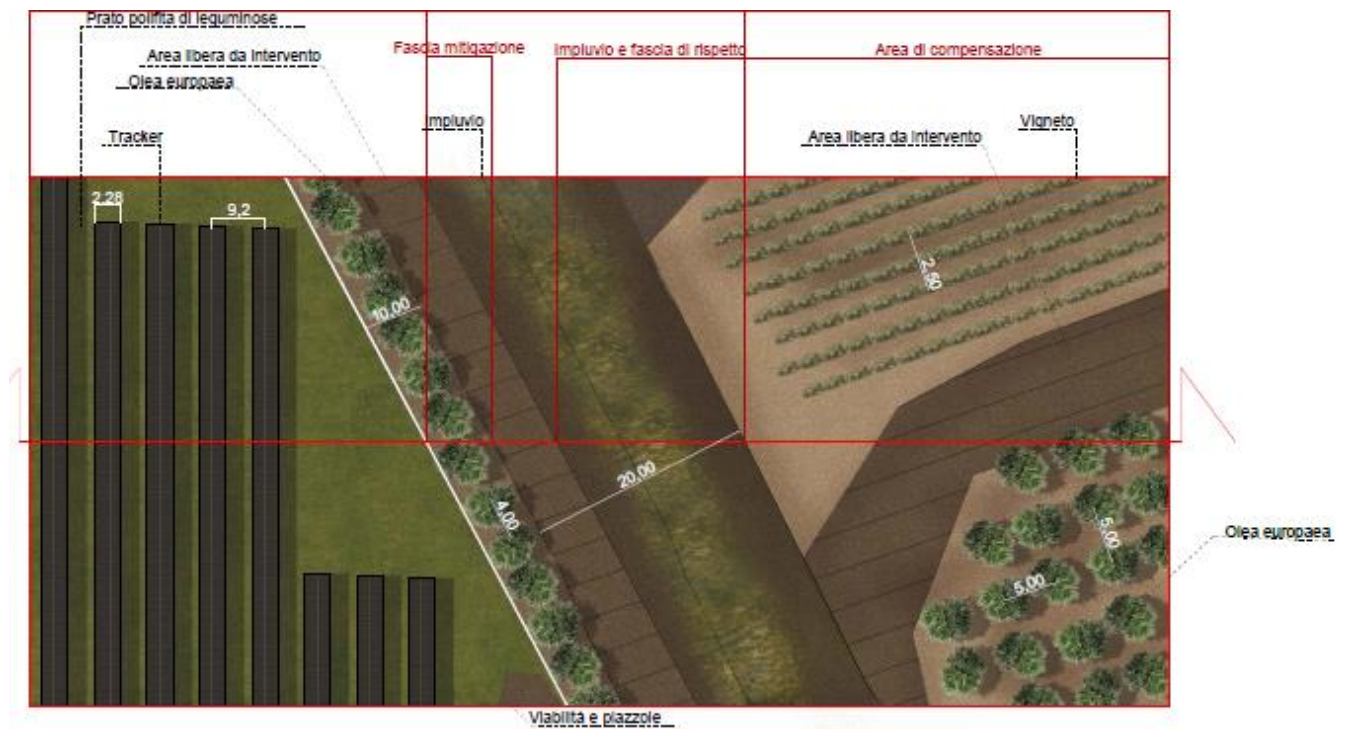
planimetria con dettaglio dell'area di impianto, del vigneto e dell'uliveto .
